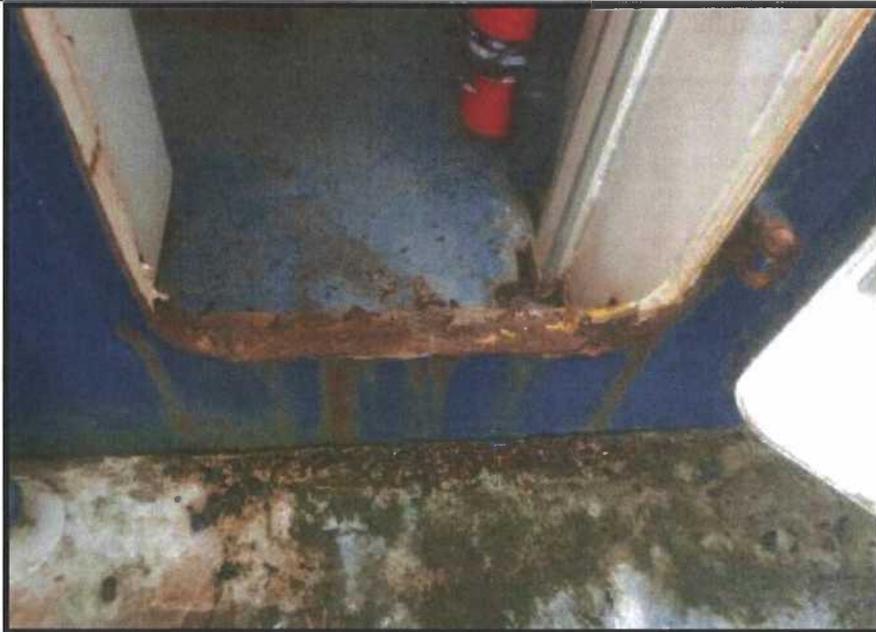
Zócalos de Puertas con excesiva Corrosión.
